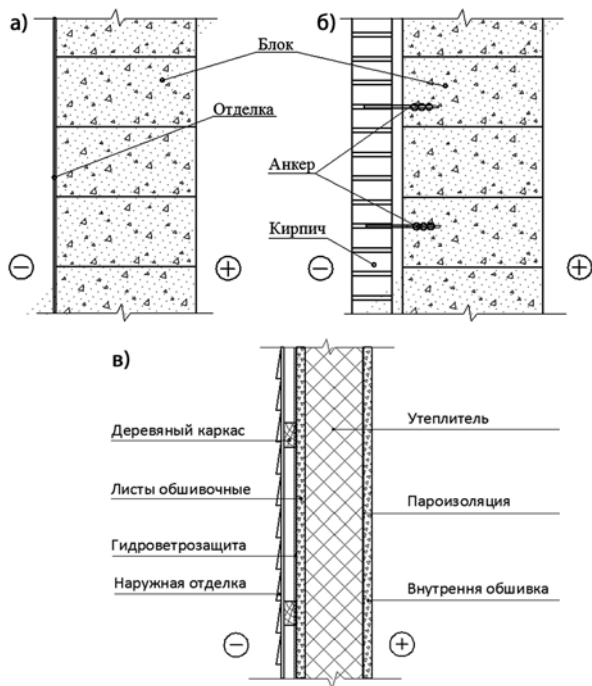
Конструктивные решения наружных стен малоэтажных зданий: а – однослойная из ячеистых блоков; б – с обкладкой кирпичом; в – многослойная.
